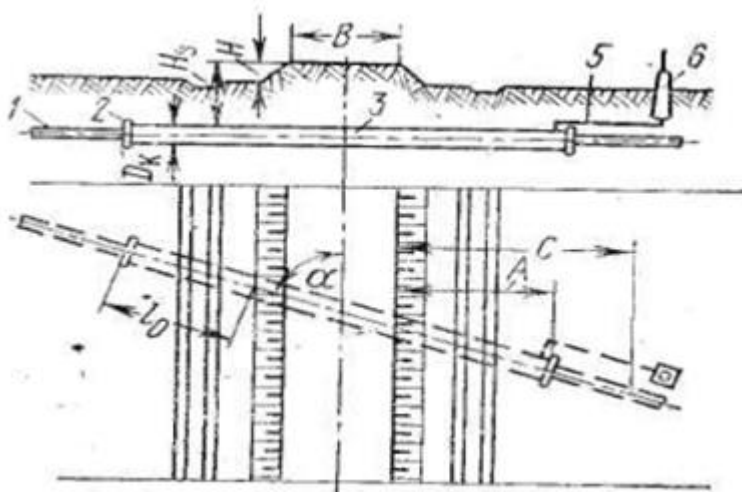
Схема конструкции перехода газопровода под автомобильной дорогой:
